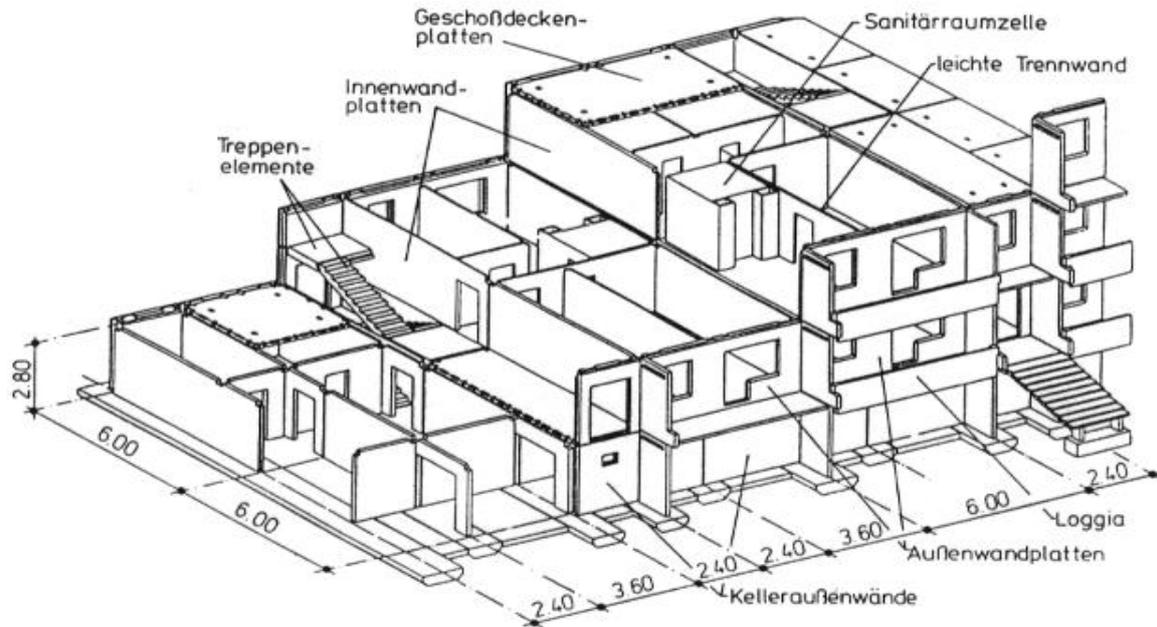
Konstruktionsprinzip Plattenbauten¹⁴
